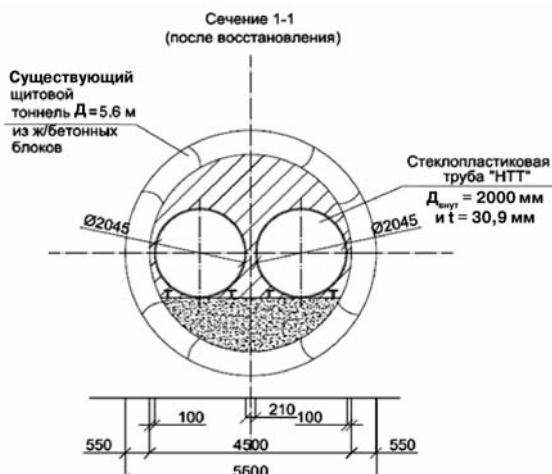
Реконструкция канализационного канала методом "труба в трубе" с использованием двух стеклопластиковых труб (ТУ 2296-004-99675234-2007)
